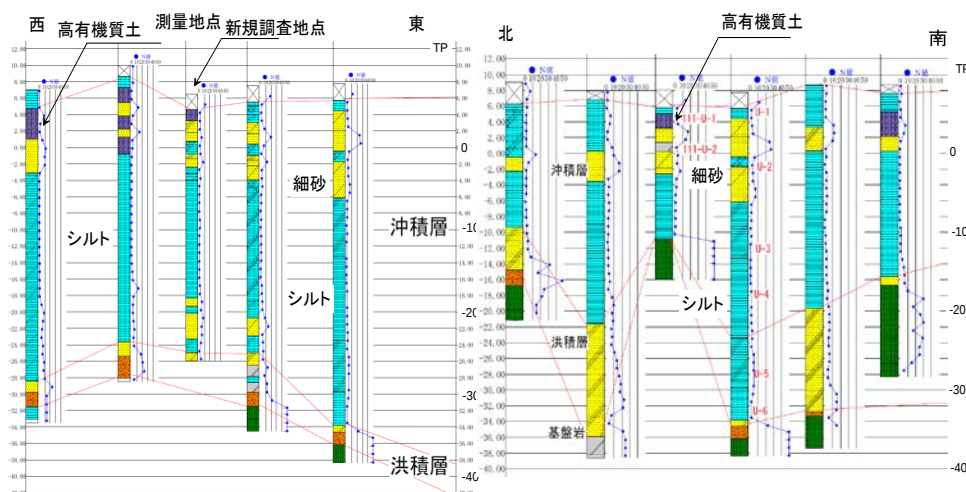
平地区の地層断面図(南北) 図-4 平地区の地層断面図(東西)
